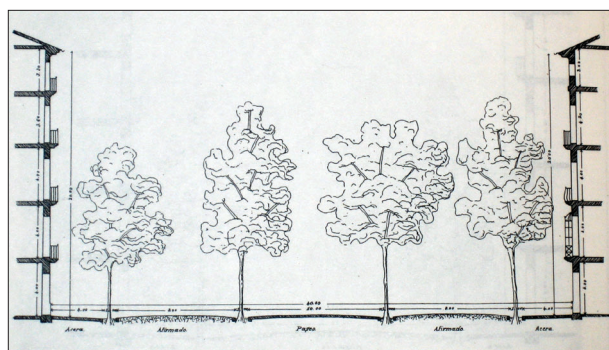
Proyecto de ensanche para Palma (Calvet): sección de las calles de primer orden
